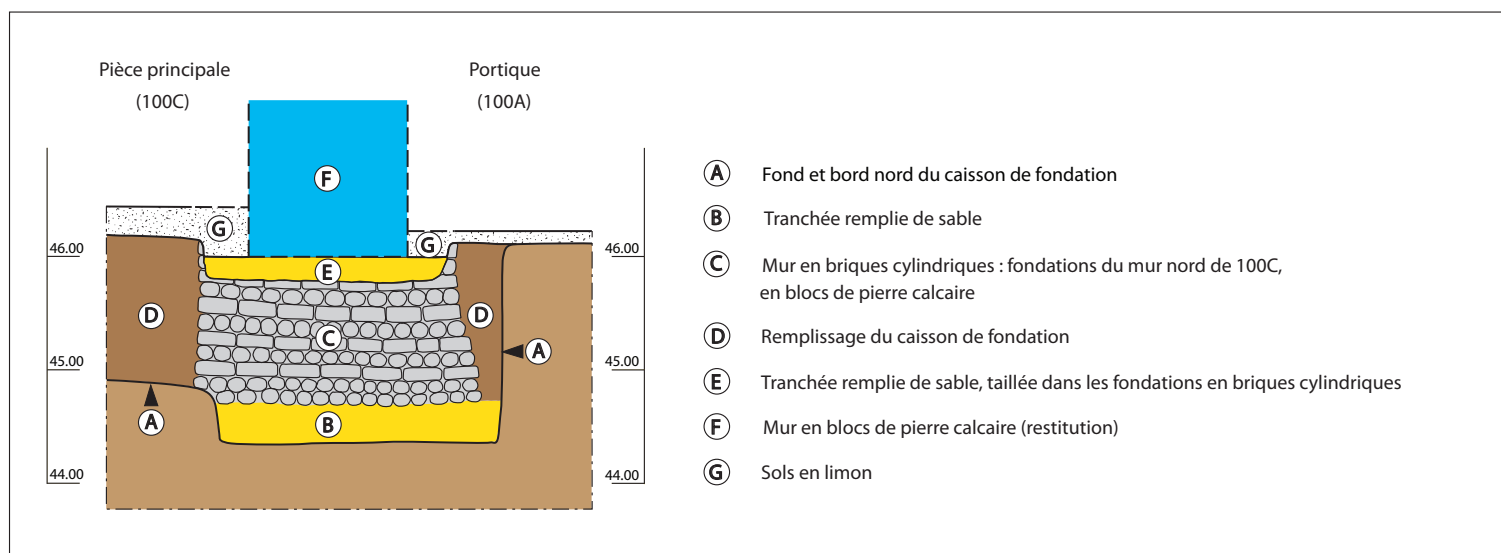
Fondations du palais : coupe à travers les fondations du mur nord de la salle principale 100C
